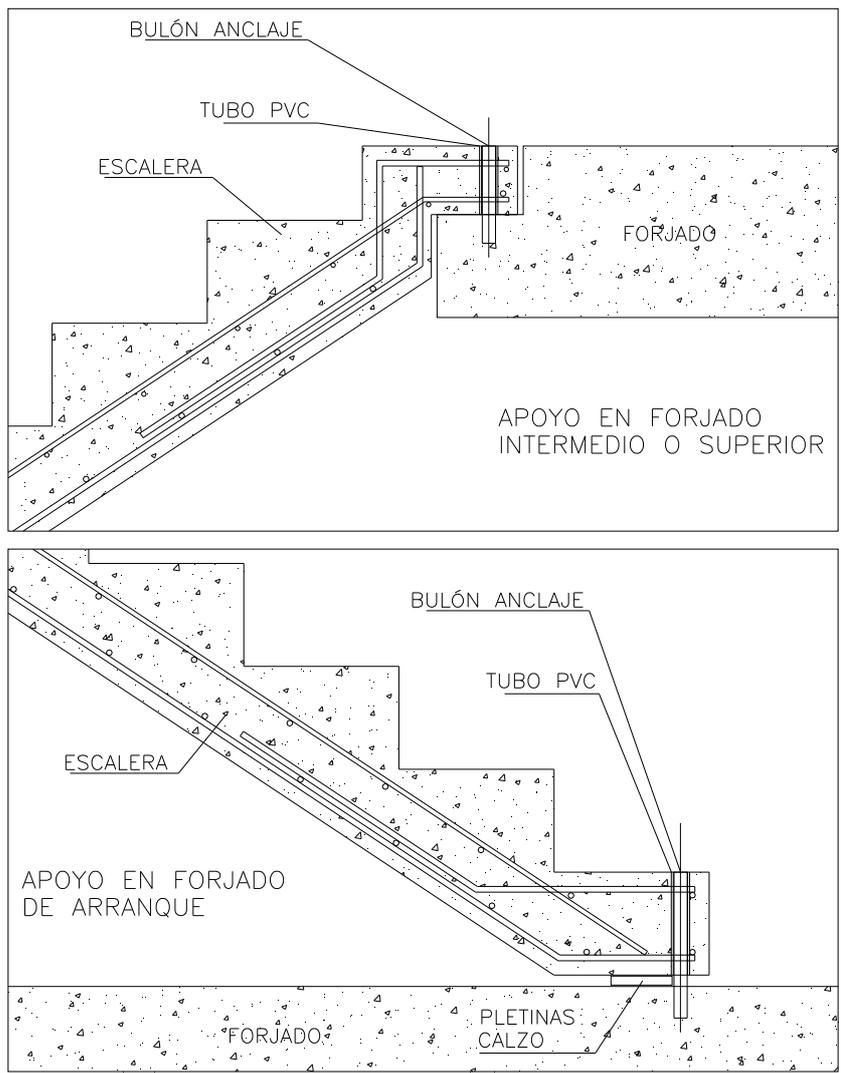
ANCLAJE DE ESCALERAS PREFABRICADAS
